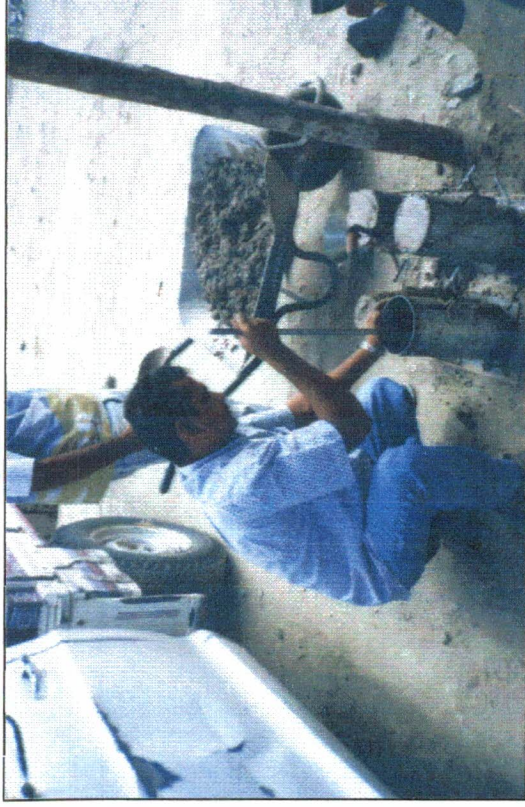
Moldagem dos corpos de prova do concreto do perfil creager.
